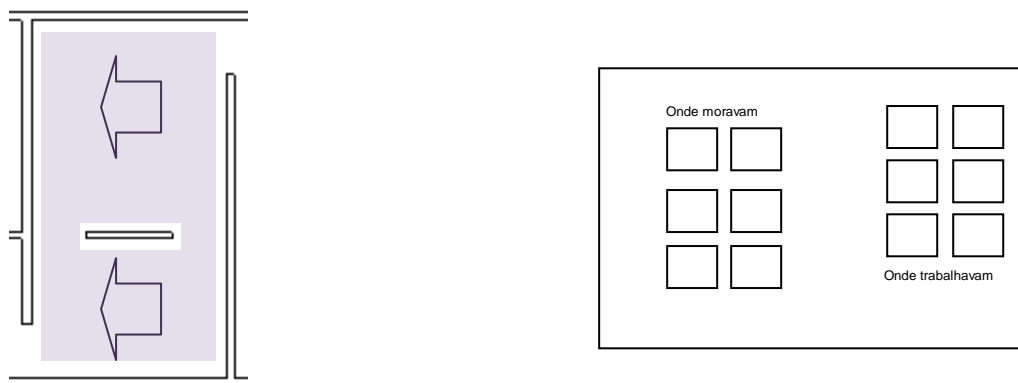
Módulo Mão de obra. Planta baixa e elevação esquemática da parede 04.
